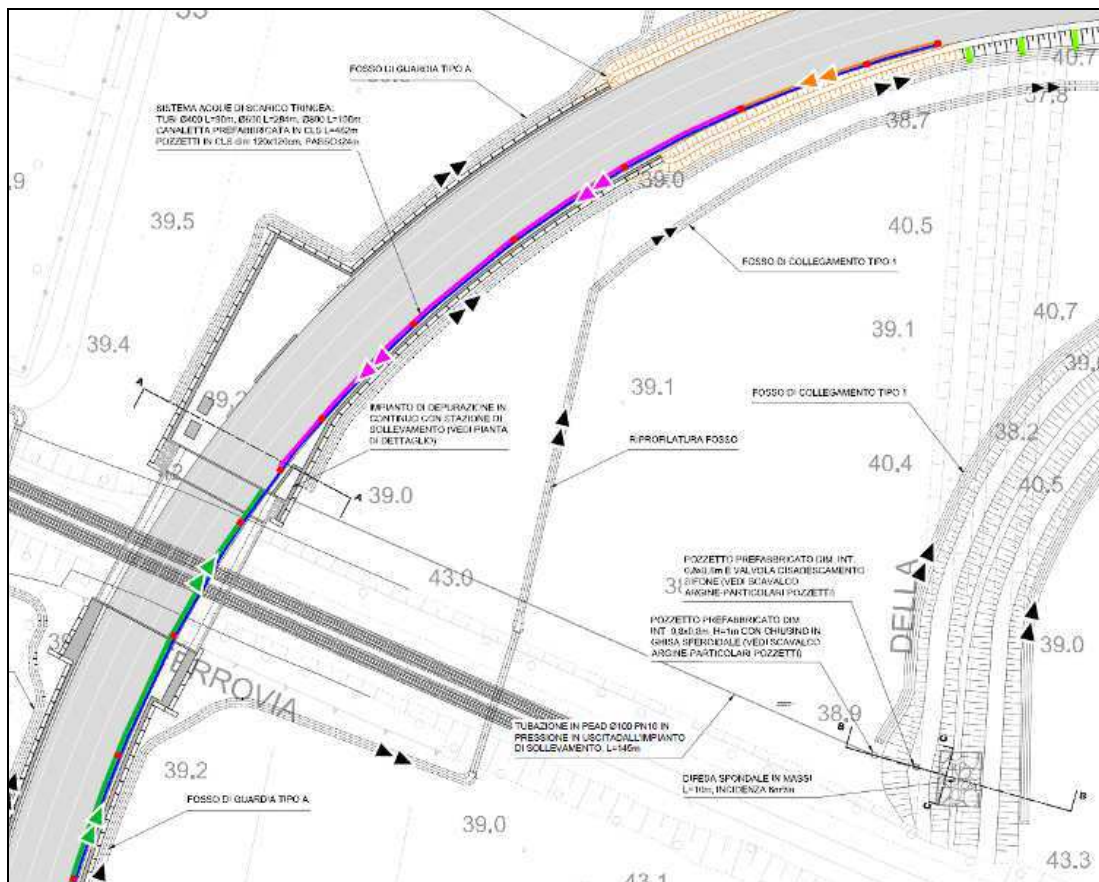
particolare planimetrico dello scricco nella Fossetta della Torretta (sponda sinistra)
